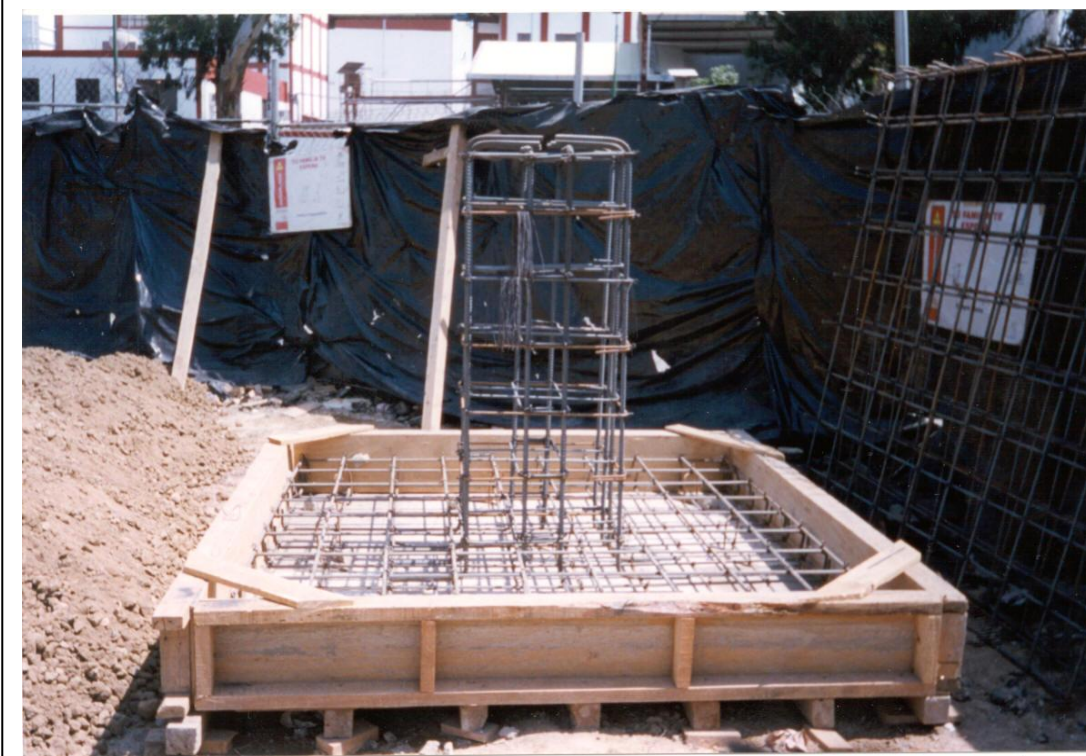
Preparación y armado de zapatas para techumbre (precoladas)
